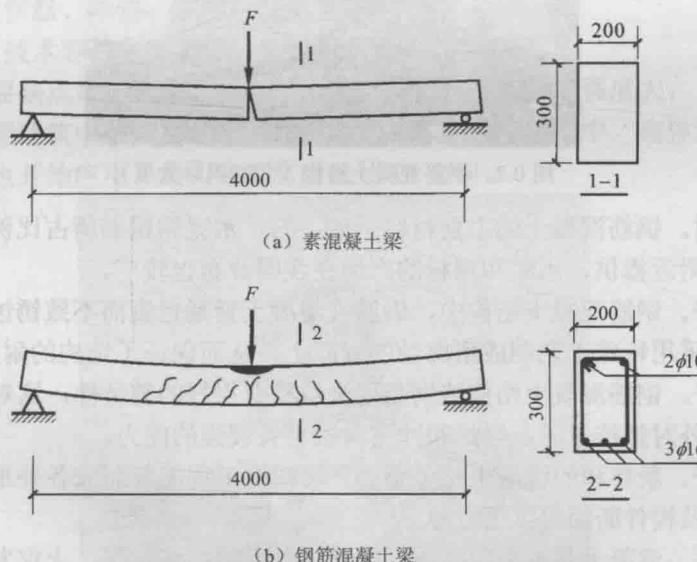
钢筋混凝土梁与素混凝土梁的破坏情况比较
